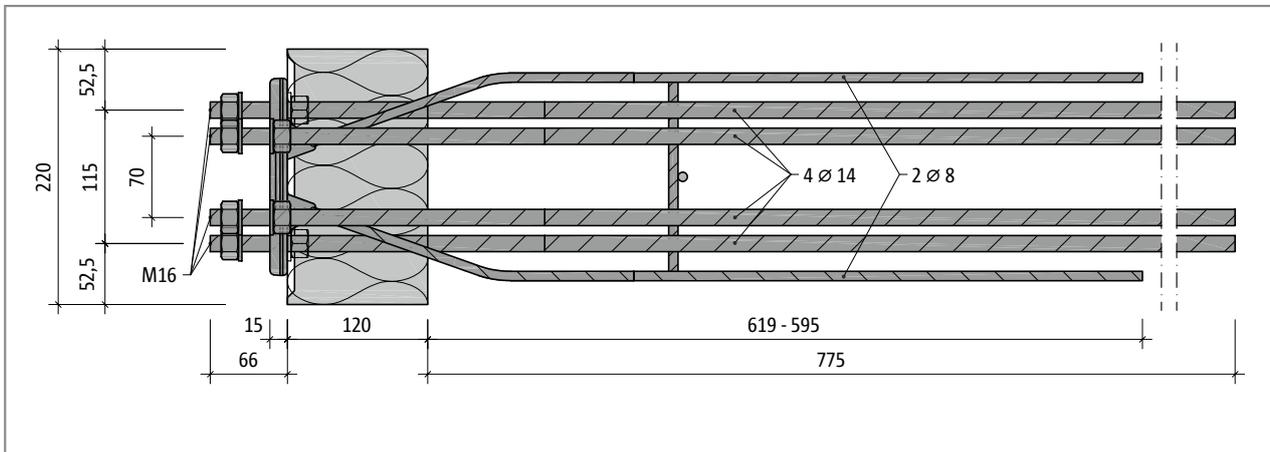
Schöck Isokorb® XT Typ SK-MM1-VV1: Grundriss
